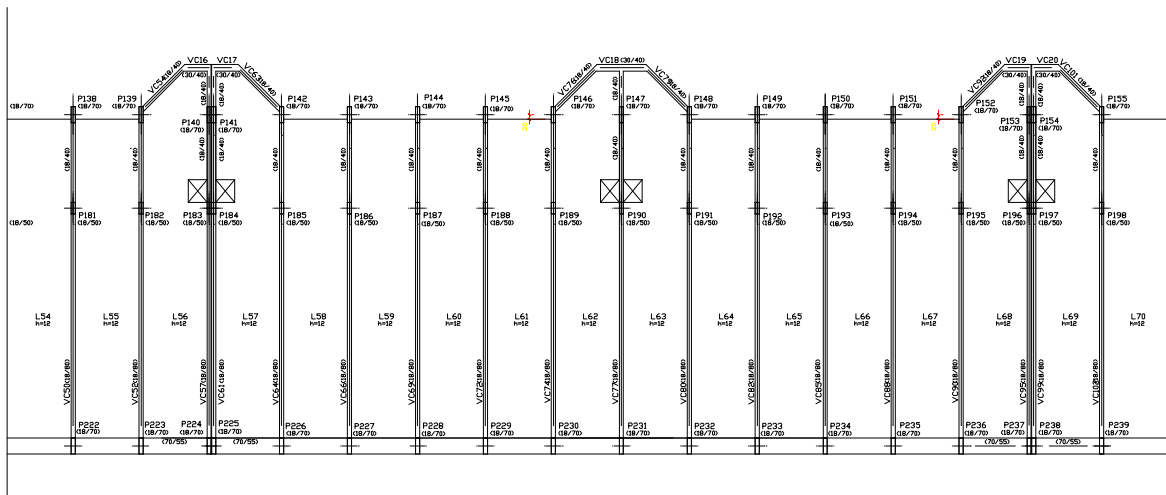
Plano geral das vigas e pilares de concreto do prédio do IQ
